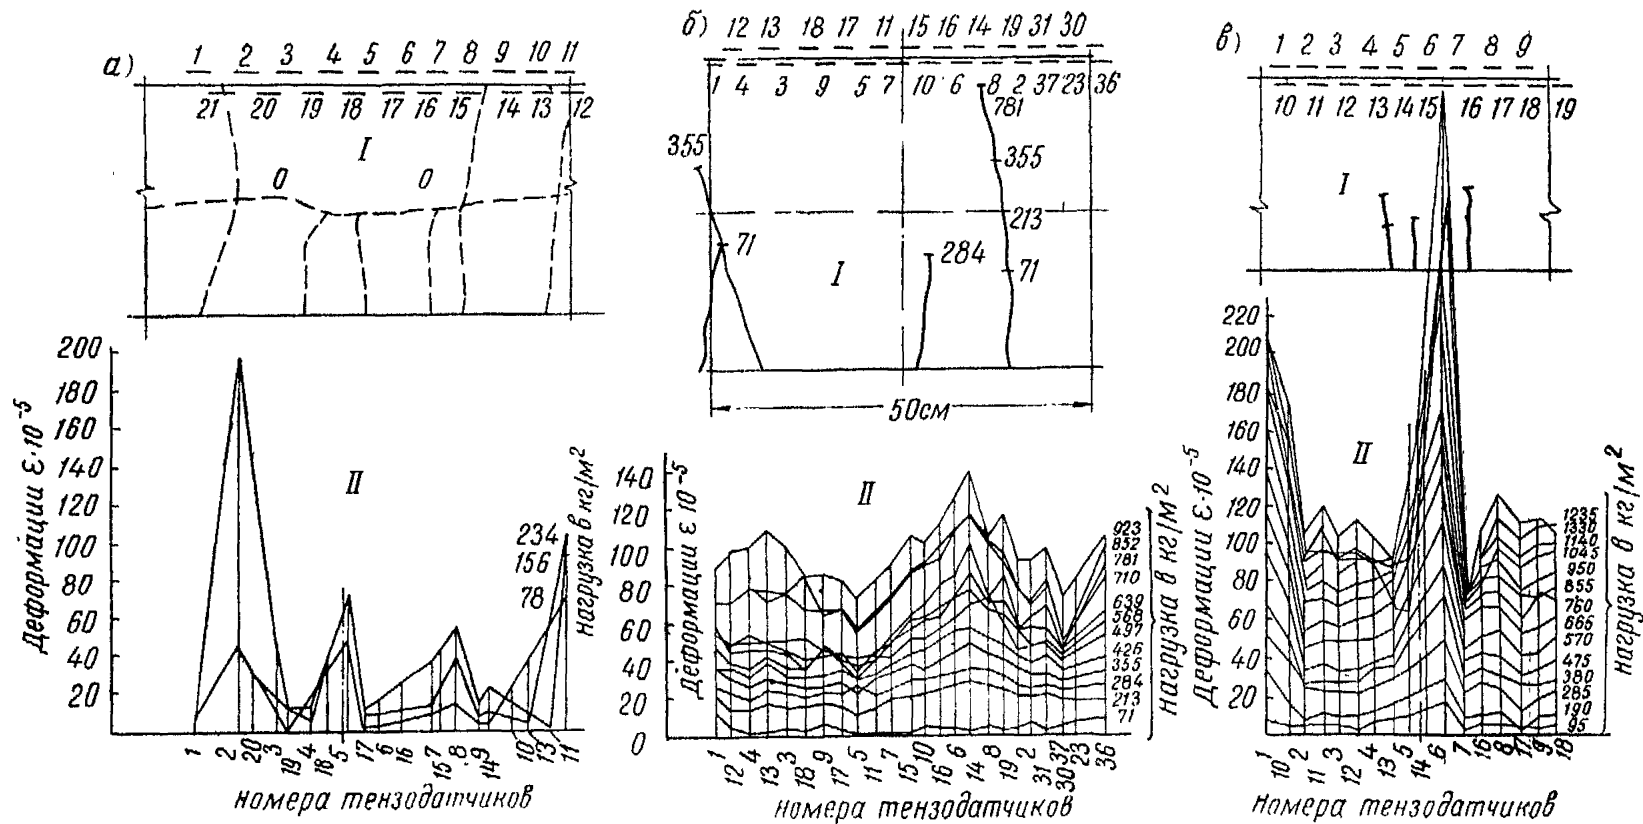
Влияние трещин в растянутой зоне на деформации сжатой зоны ячеистого бетона в плитах
